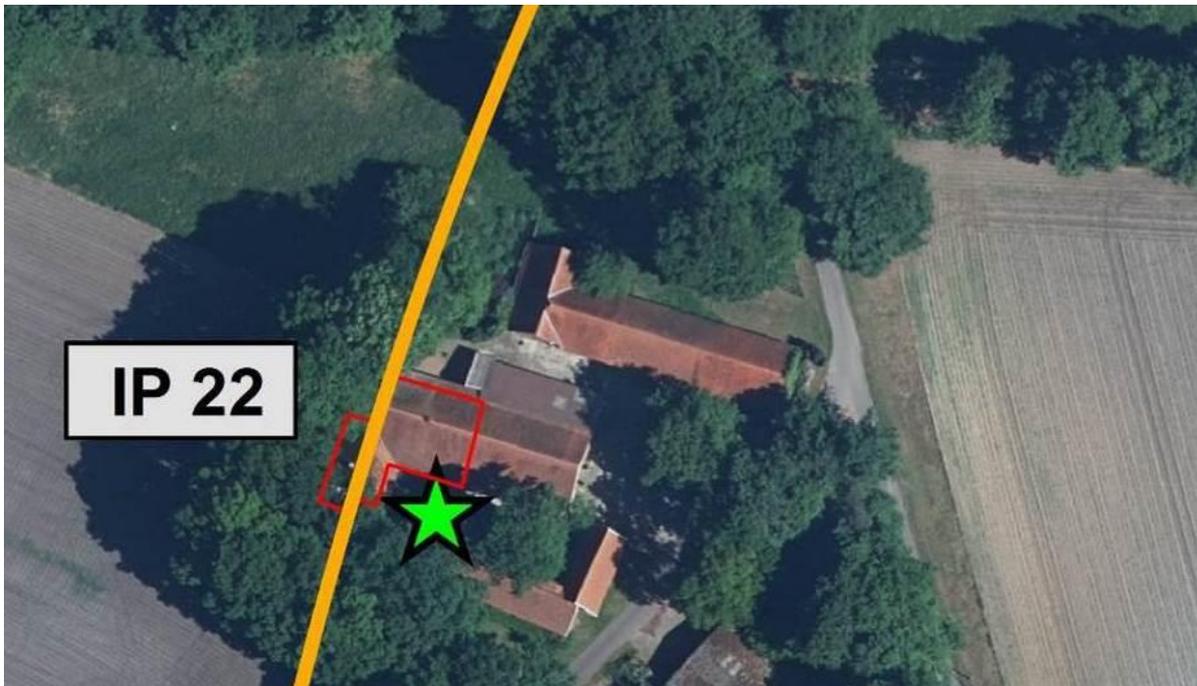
IP 22 – Lageplan Grundstück und Gebäude (grüner Stern = gebäudenaher Außenwohnbereich)
